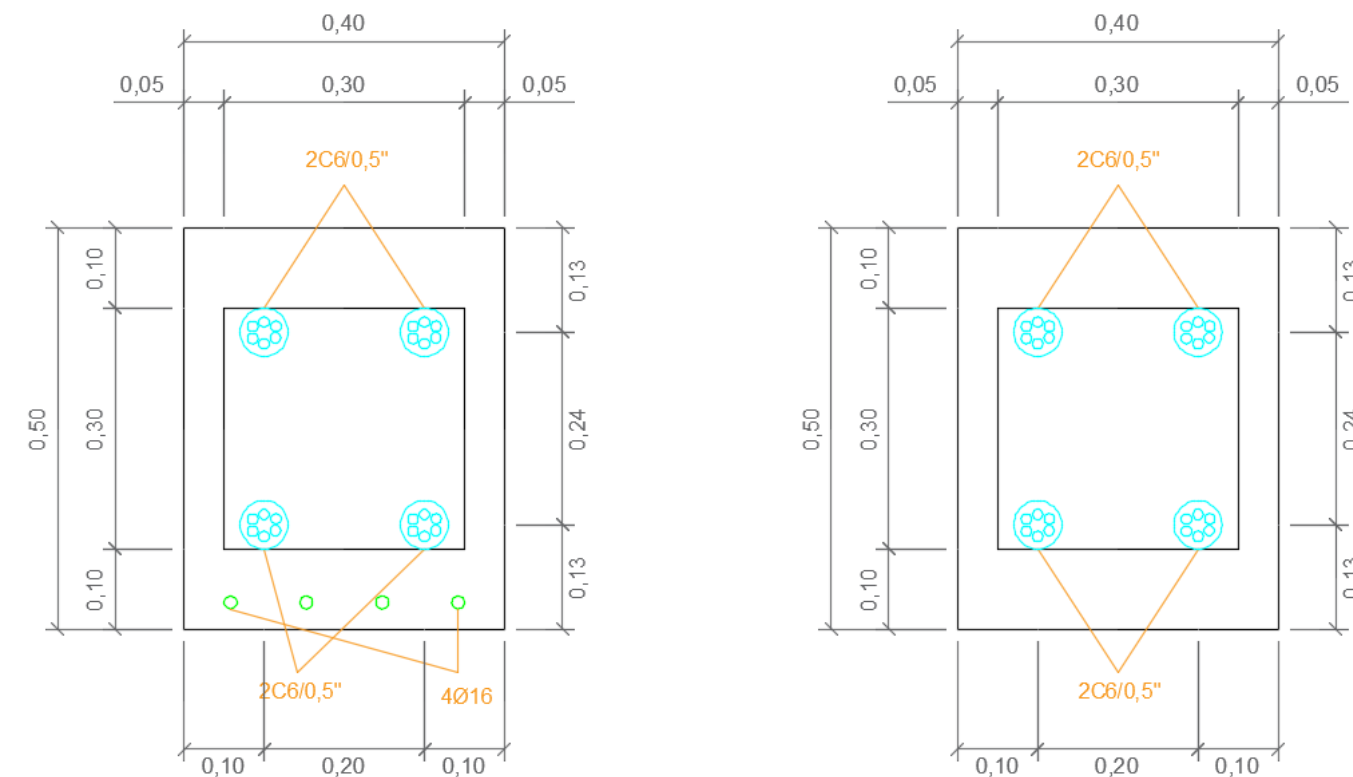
Sección tipo de la viga longitudinal en zona aligerada, tramo inicial (izquierda) y tramo intermedio (derecha)
